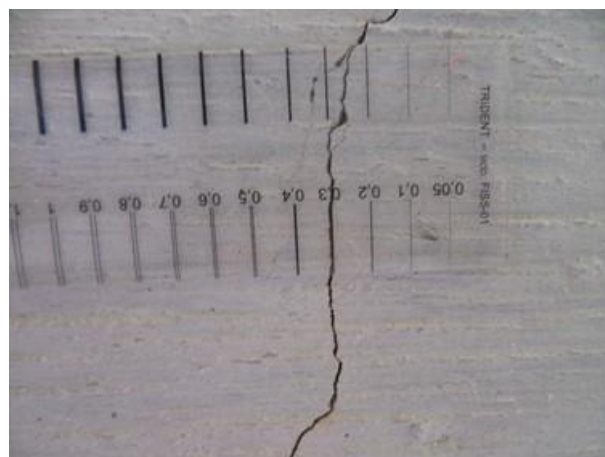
Balanço Oeste – Fissura com abertura igual a 0,3mm.
